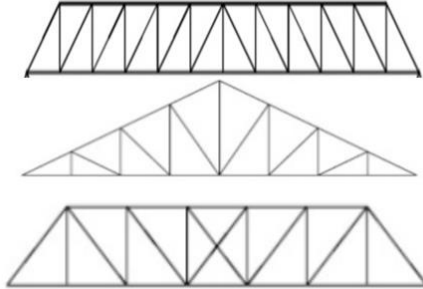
Armaduras tipo Howe (Bellido et al., 2015)
